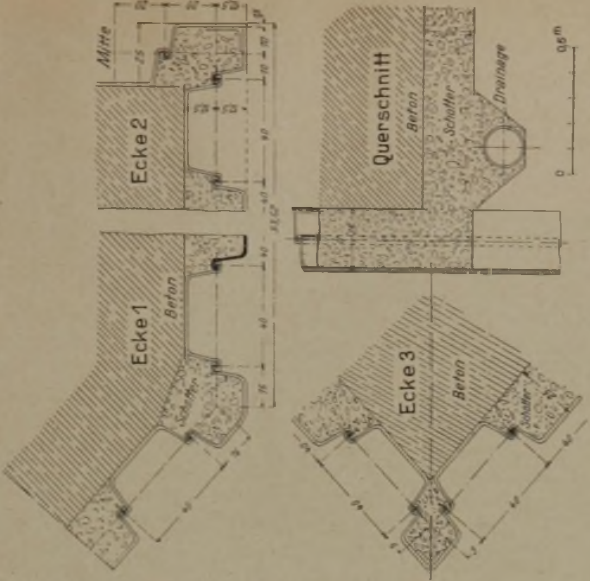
Einzelheiten der Baugruben-Umschließung vom Pfeiler 3 mit eisernen Spundwänden nach Ausbetonierung. (Vgl. dazu Abb. 3) (Maßstab 1 : 30.)
